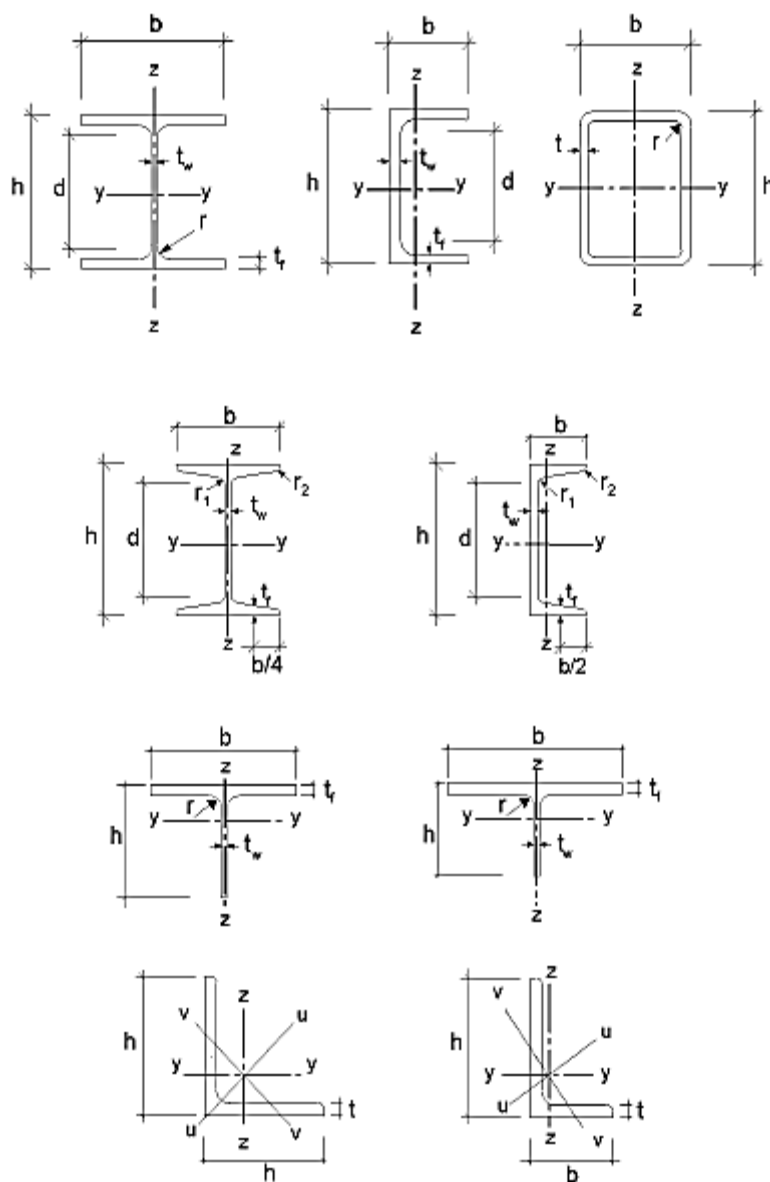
Convenção, dimensão e eixos das secções, [10]
